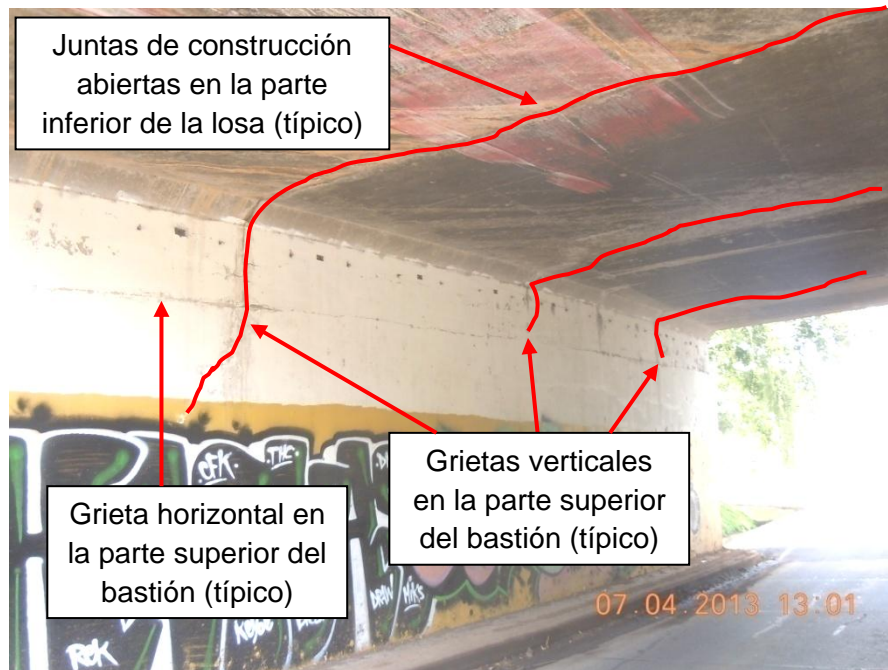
Grieta horizontal en la parte superior del bastión 1 y grietas verticales producto de las juntas de construcción de la losa paralelas a la dirección del tránsito que se han abierto. (típico)
